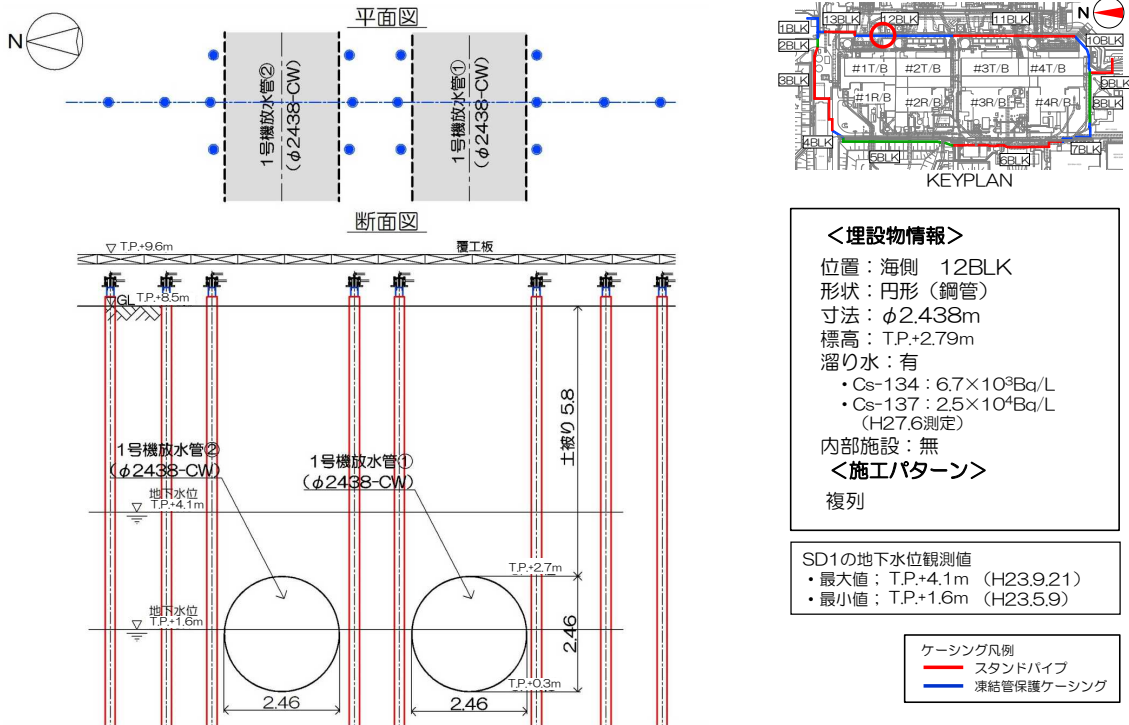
【12-7】1号機放水管①② 施工方法（複列施工）
